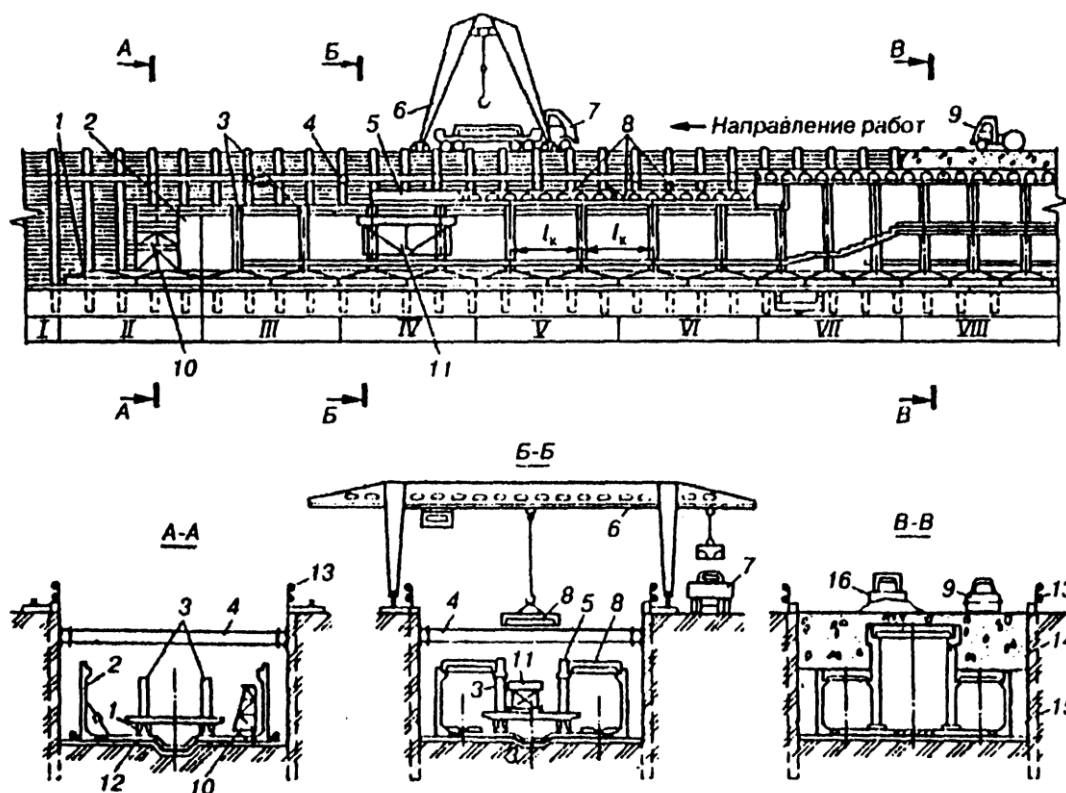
Схема зведення станції зі збірного залізобетону у котловані з пальовим кріпленням:
